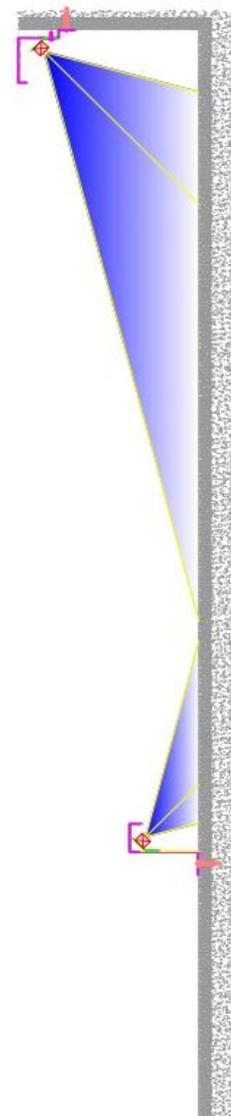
SEZIONE DELLA PARETE E DELLE DUE PLAFONIERE
